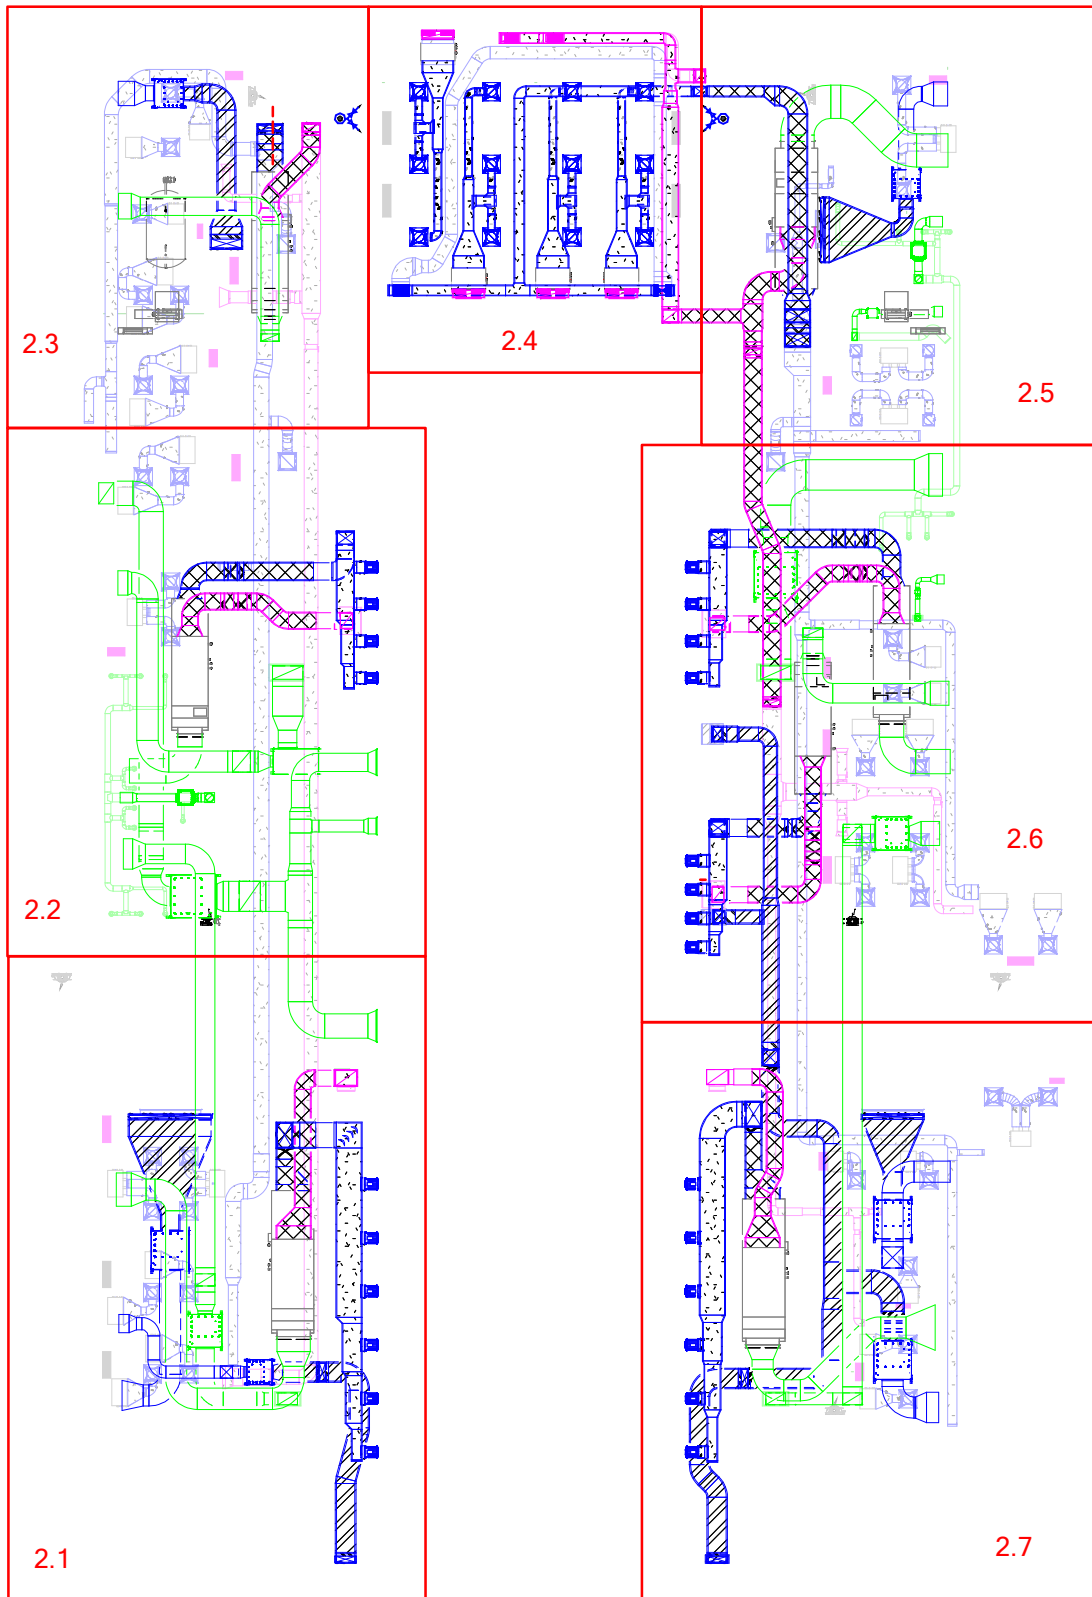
Seções da planta geral do traçado das condutas na mezzanine à escala 1:250.
